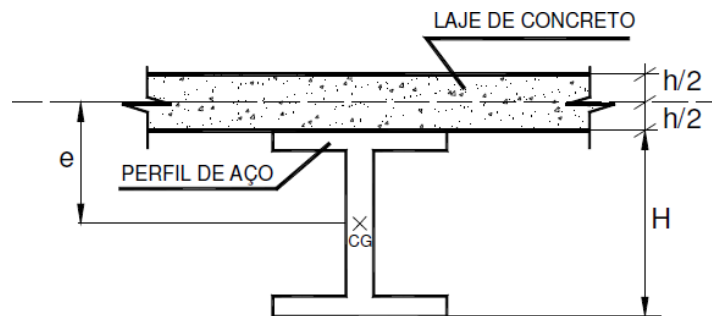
Visualização da excentricidade entre a laje e a viga (MELLO 2009).
